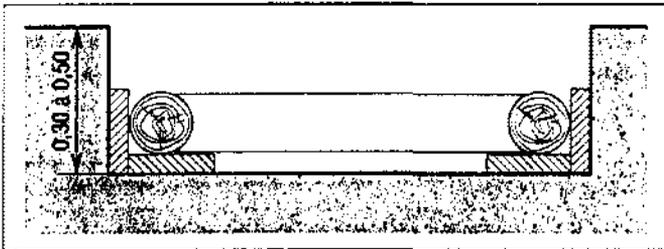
Pose de la longrine supérieure. Coupe verticale.
